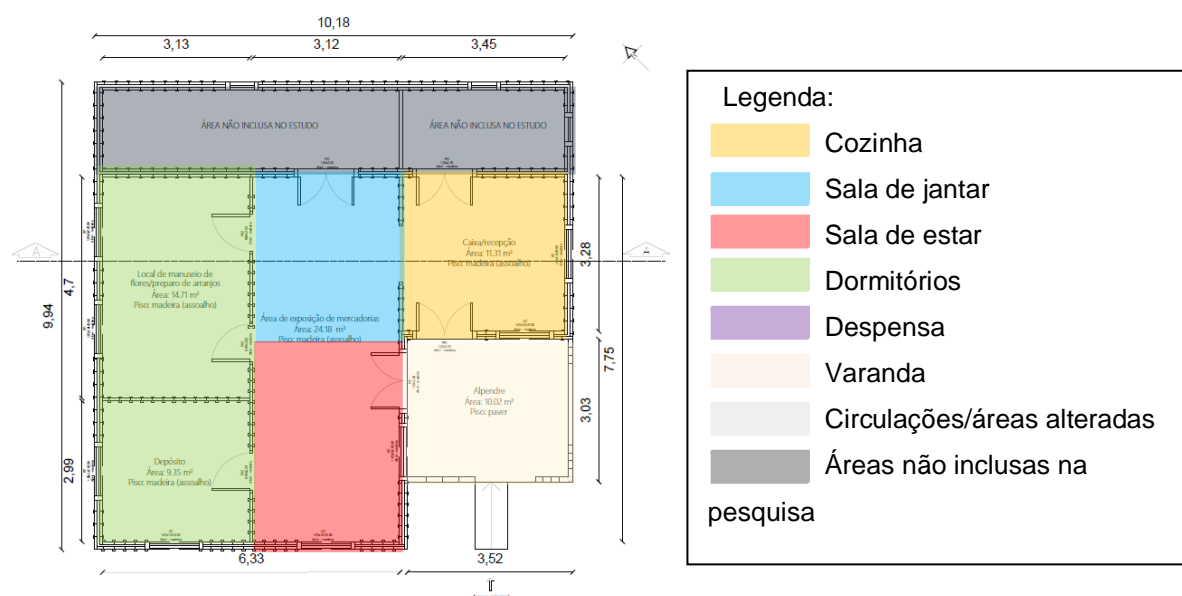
Planta baixa da Ficha 02, residência Taube.
